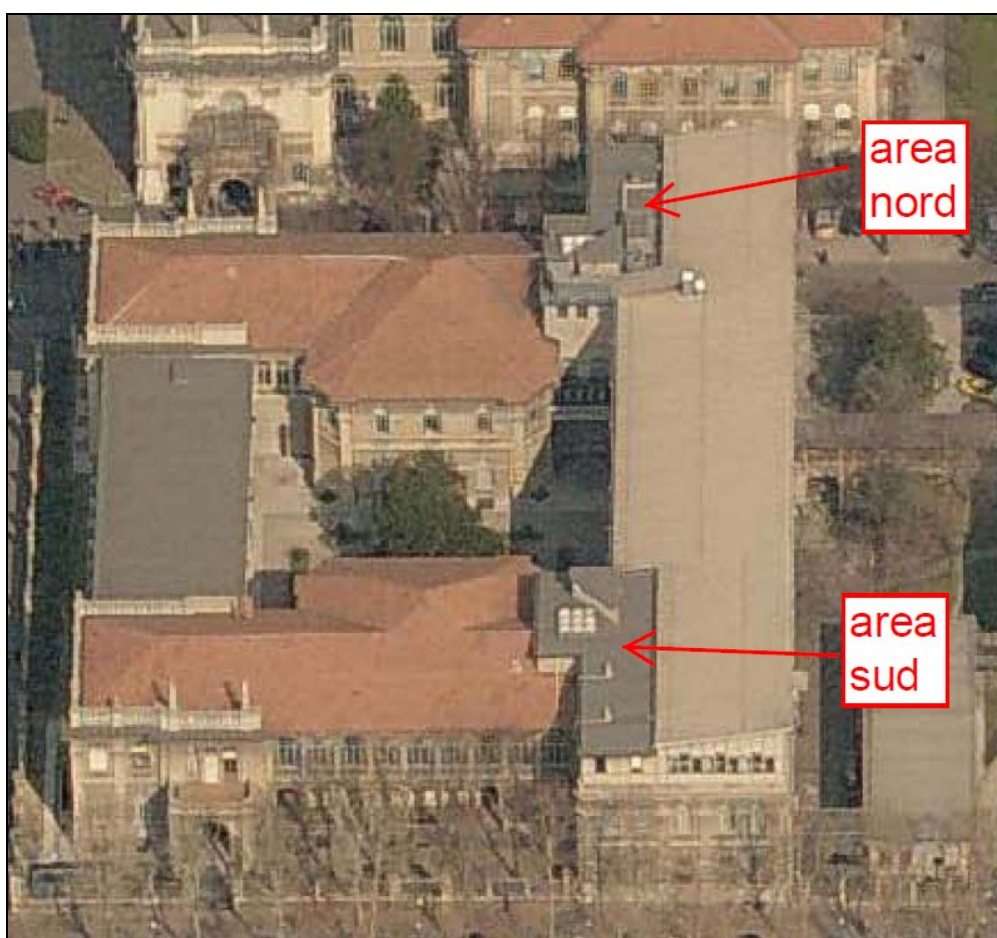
Vista dall'alto dell'Edificio 3 – evidenziazione aree piane
